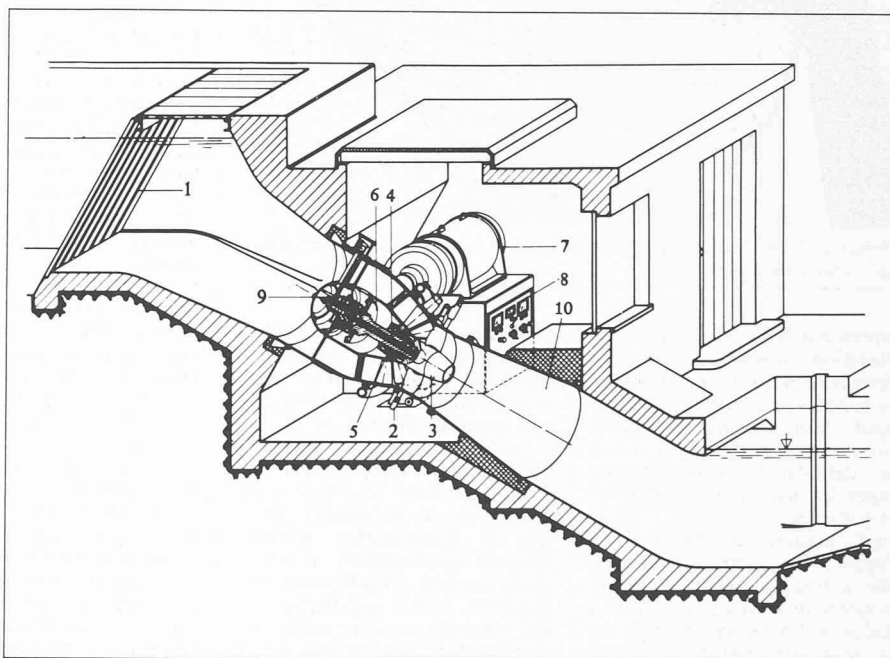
Turbine bulbe à alternateur extérieur entraîné par engrenage conique.
